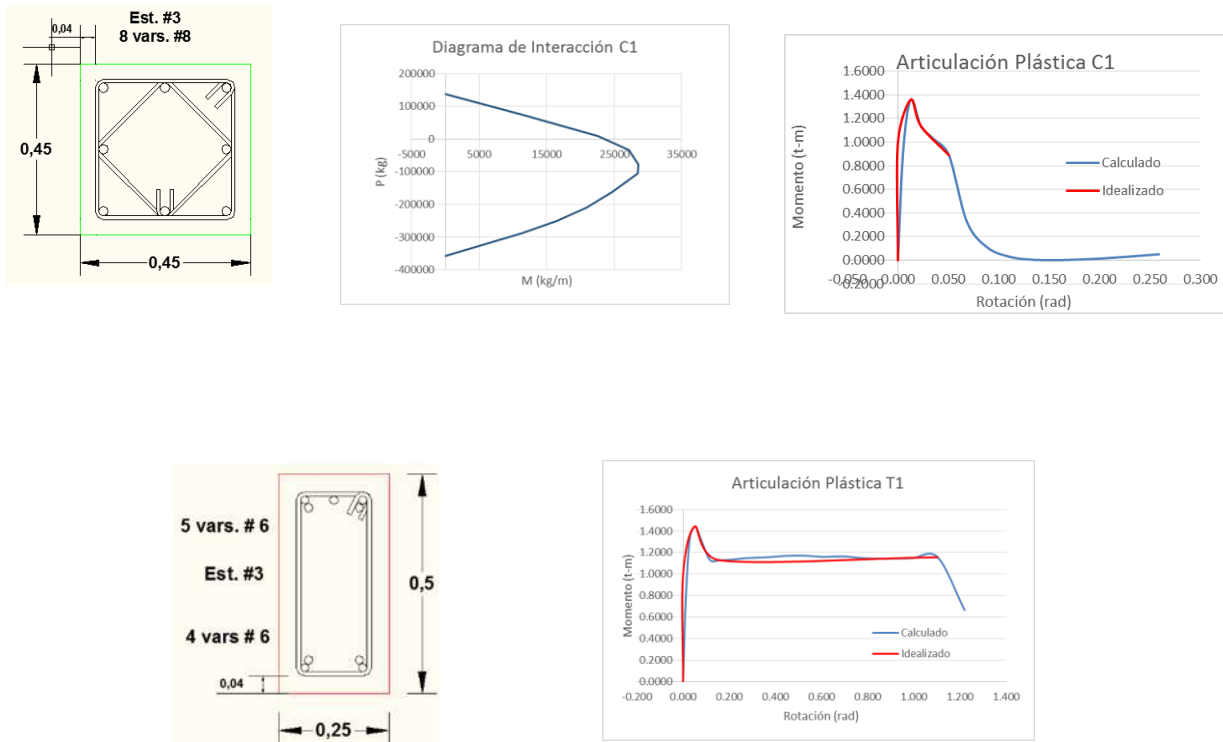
Propiedades del comportamiento de los elementos estructurales del edificio.
